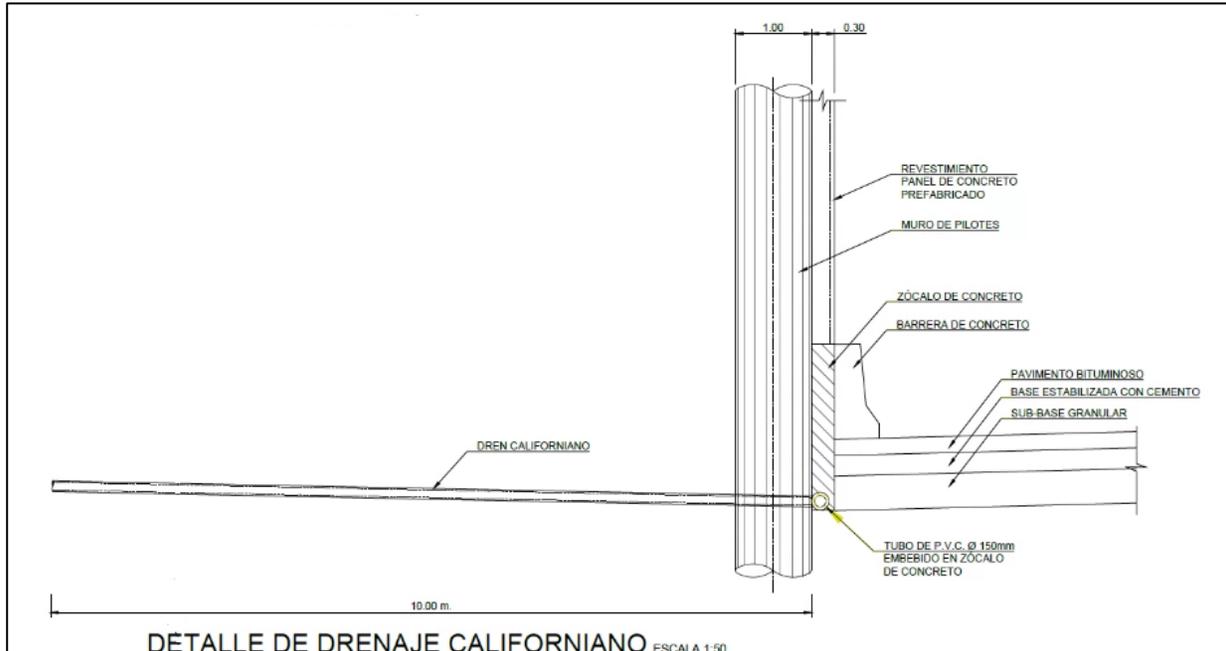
Detalle según planos del drenaje para los muros pantalla de pilotes
